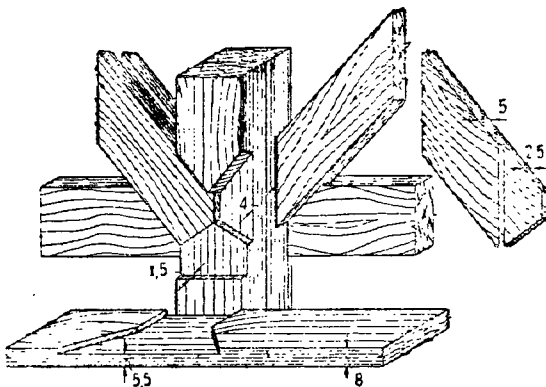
Средний узел нижнего пояса фермы с деревянными стойками
